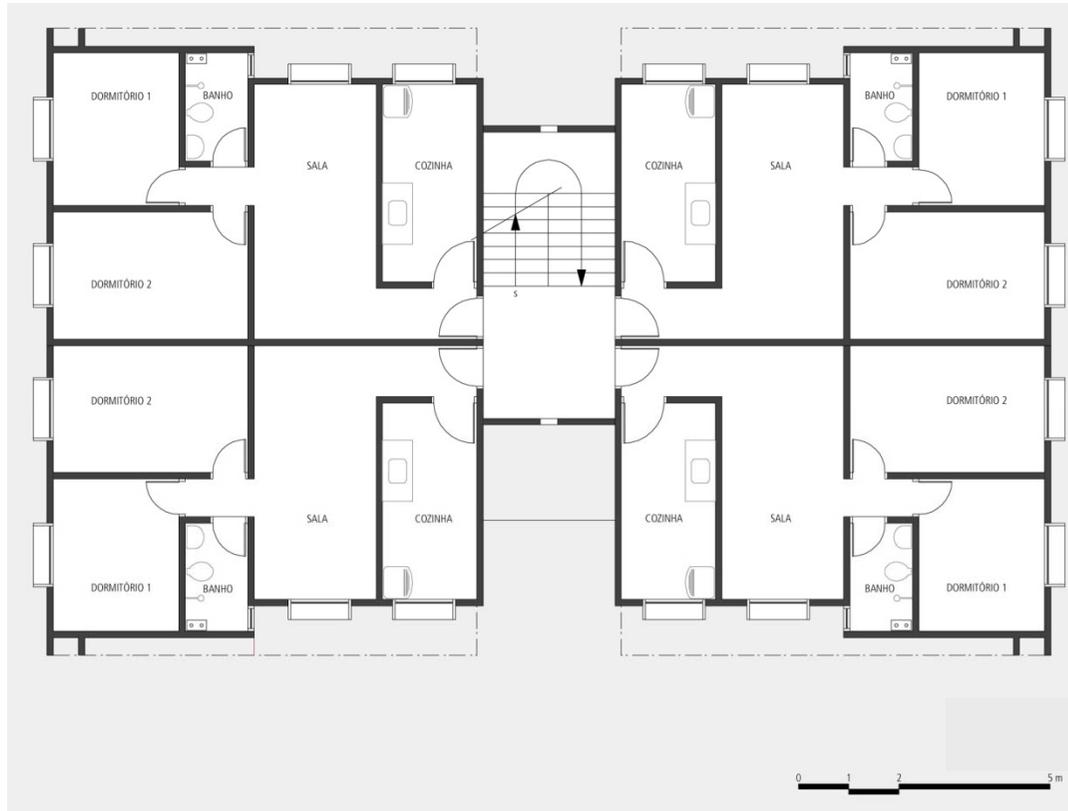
Planta baixa do andar do edifício do Conjunto habitacional Cazuzu.
